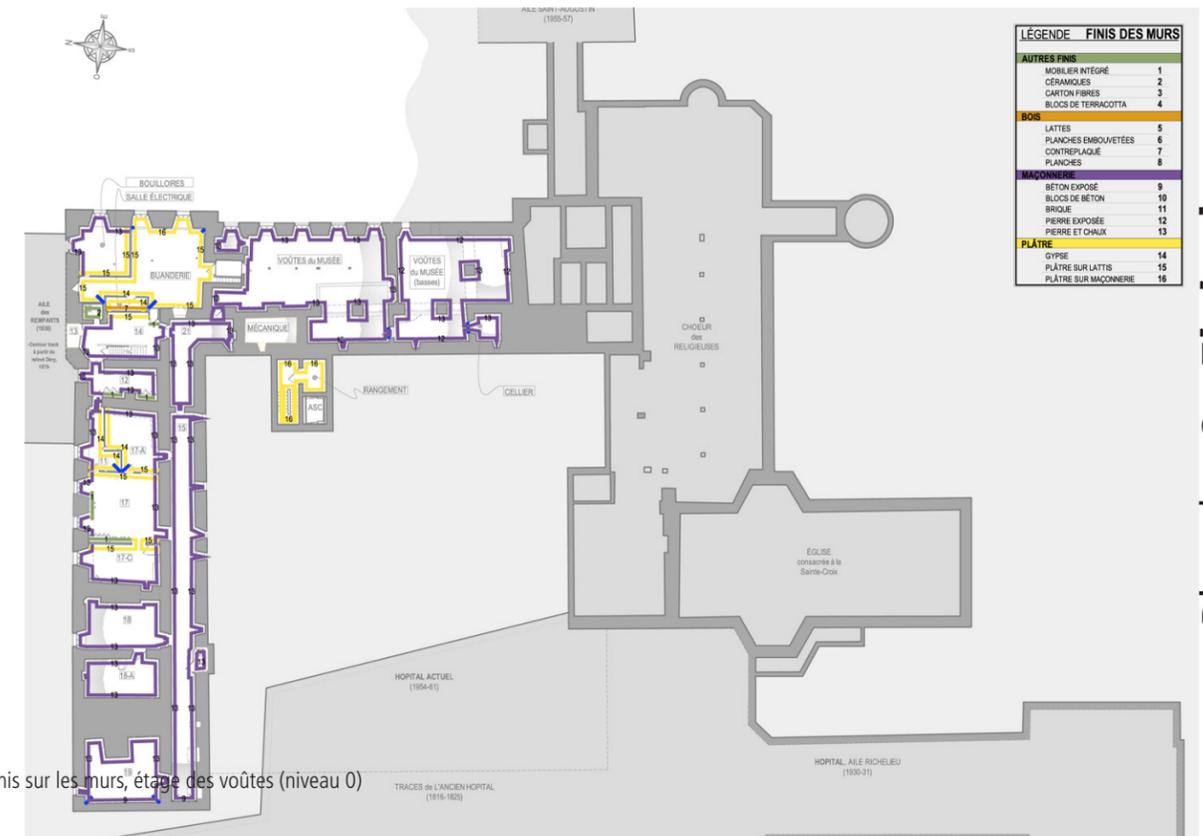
Plan des finis sur les murs, étage des voûtes (niveau 0)
